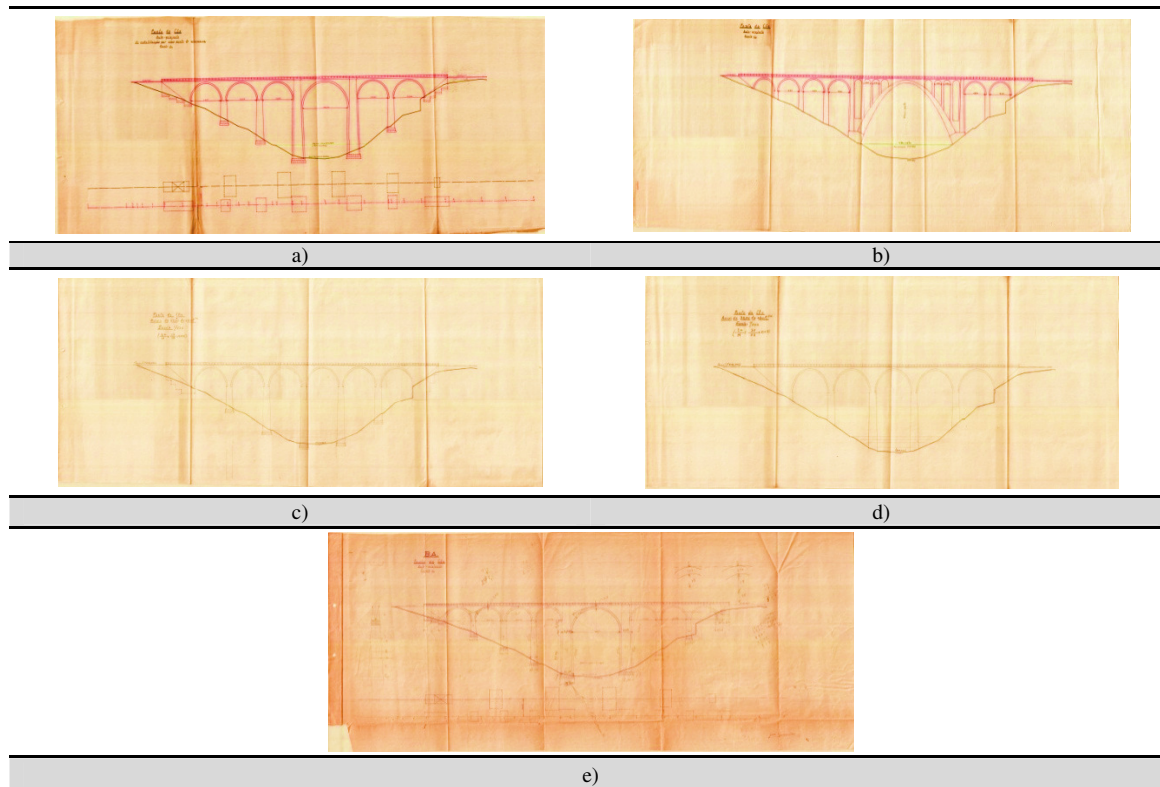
Propostas de construção da nova ponte do Côa em arcos de alvenaria
